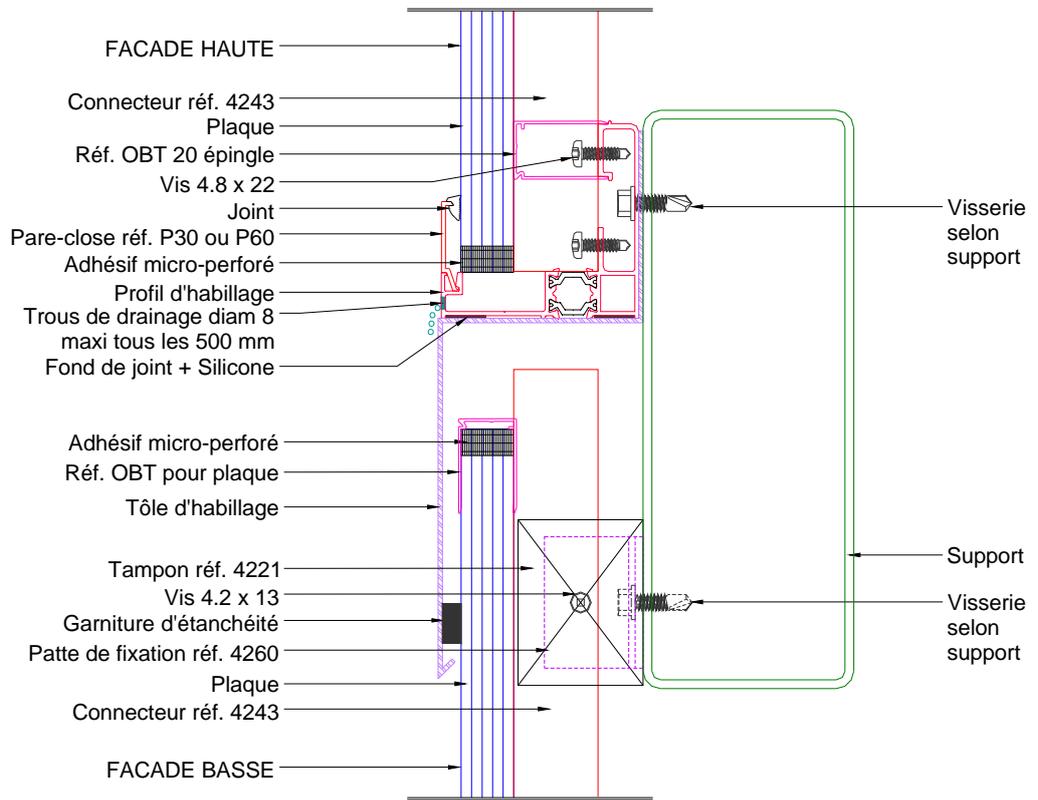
Pose normale - Raccord de hauteur n°3 : façade basse limitée à 16 mètres de haut
